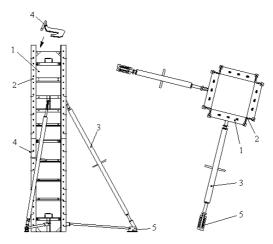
Схема устройства опалубки прямоугольных колонн: 1 — щит; 2 — наружный угол; 3 — регулируемый подкос; 4 — замок; 5 — подпятник
